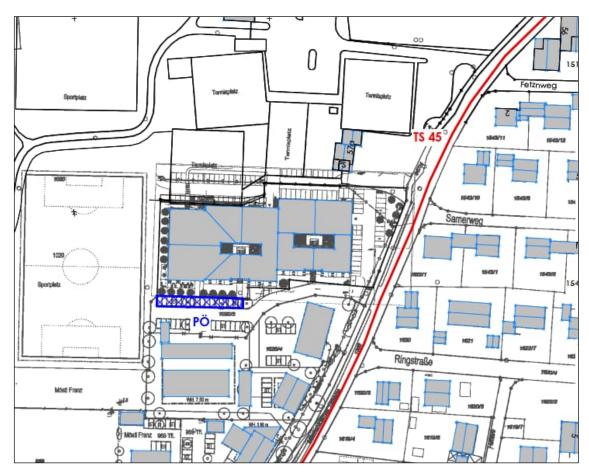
Lageplan mit Darstellung der Parkflächen
